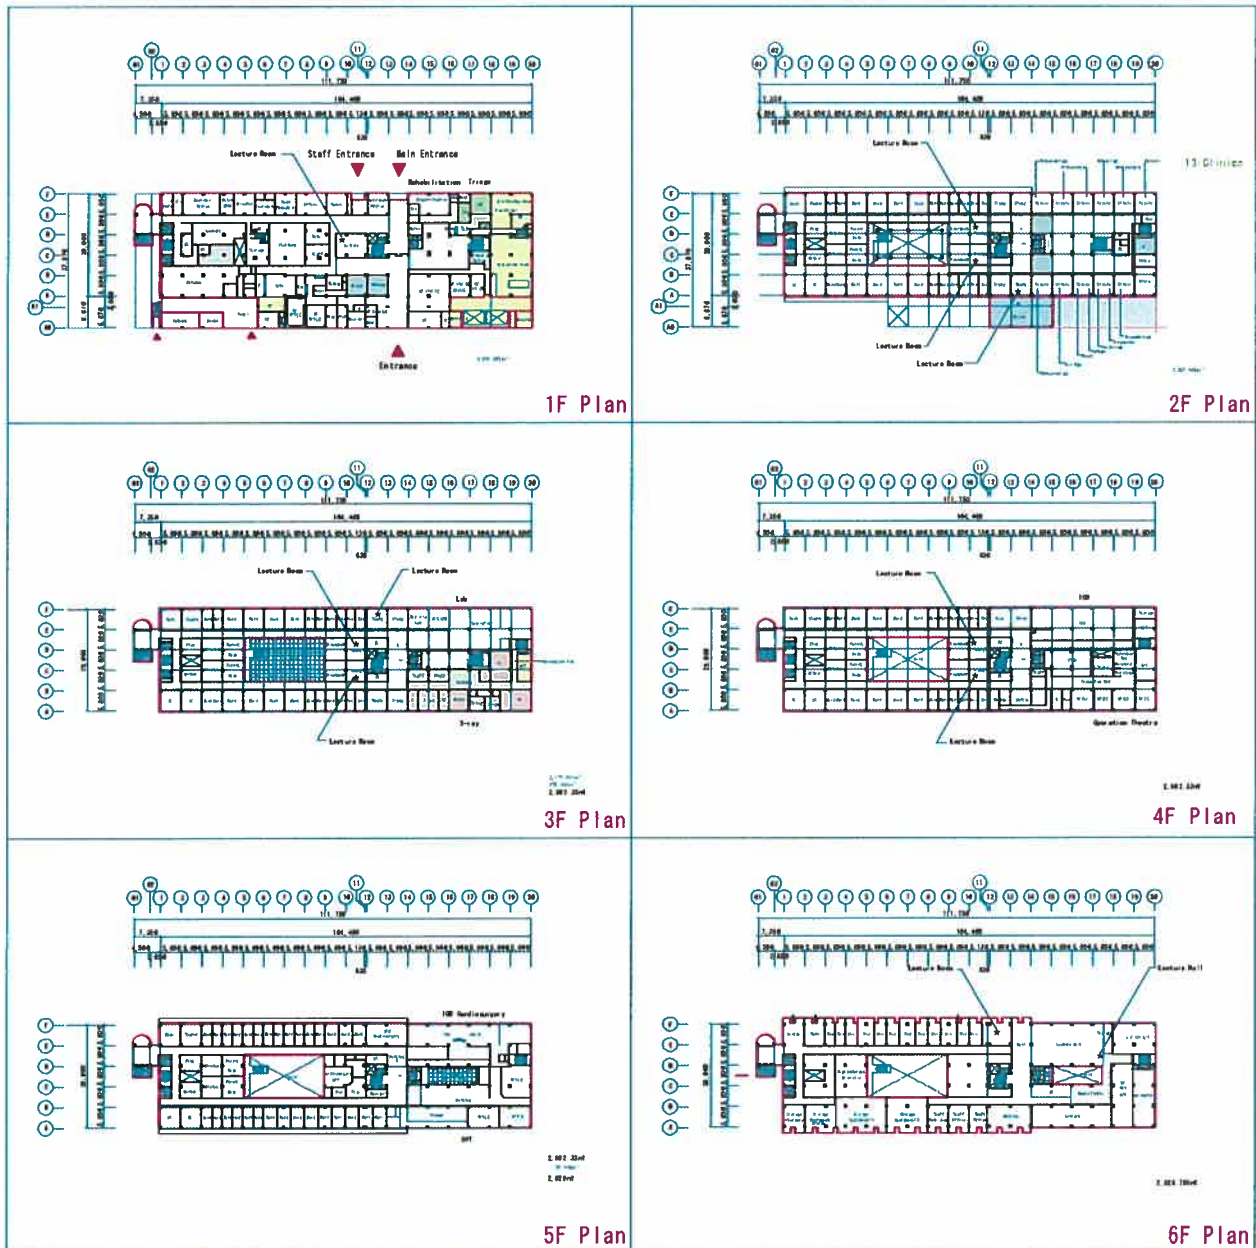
1 CUSPH の現況平面図及び研修室配置図
